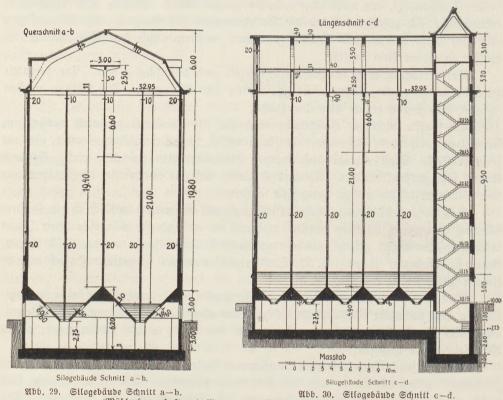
Silogebaube Schnitt c-d. (Mühlenbauanftalt und Maschinenfabrit vorm. Gebr. Sed. Dresben.)
